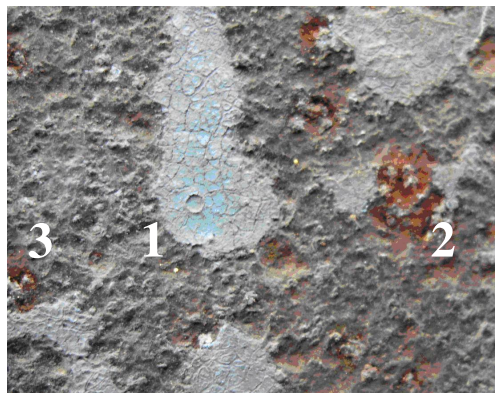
Поверхность несущего уголка опоры № 2 ВЛ 110 кВ «ЗайГРЭС - Каргали» (срок службы 43 года) 1 – зона остаточного защитного покрытия металла; 2 – зона коррозионного разрушения металла; 3 – зона пассивного состояния металла
